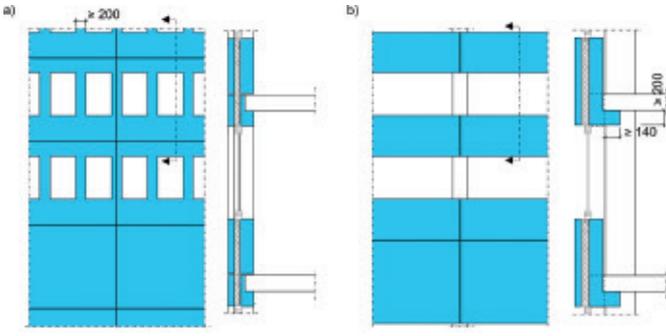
Schematische Ansichten und Fassadenschnitte bei zwei Tragwerksarten a) Fassade mit direkter Lastabtragung (hier: Lochfassade), b) Fassade mit Lastabtragung durch Stützen (hier: Bandfassade)
